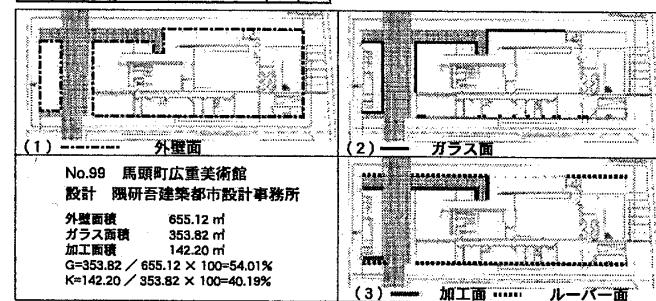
計測例 図1註 平面図に加え立面図、断面図等を用いて算出している。
